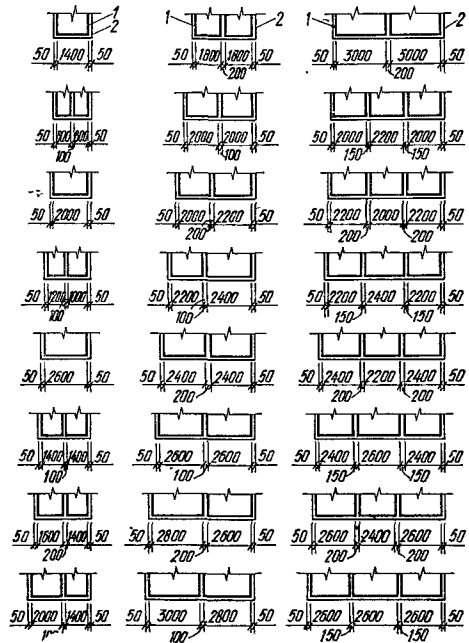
Раскладка сварных унифицированных сеток одного слоя по подошвам отдельных фундаментов колонн:
